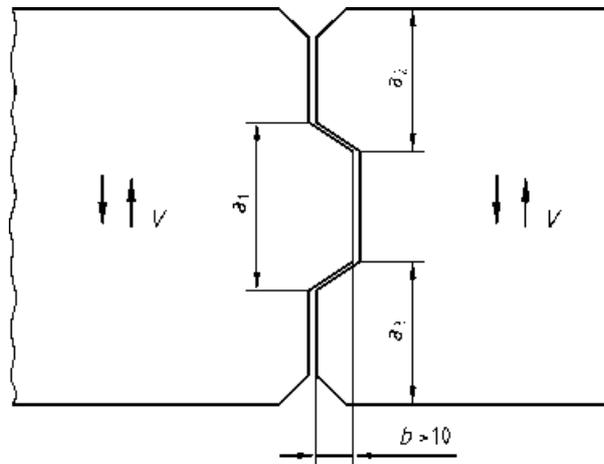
Beispiel für eine trockene Fuge mit Nut und Feder
